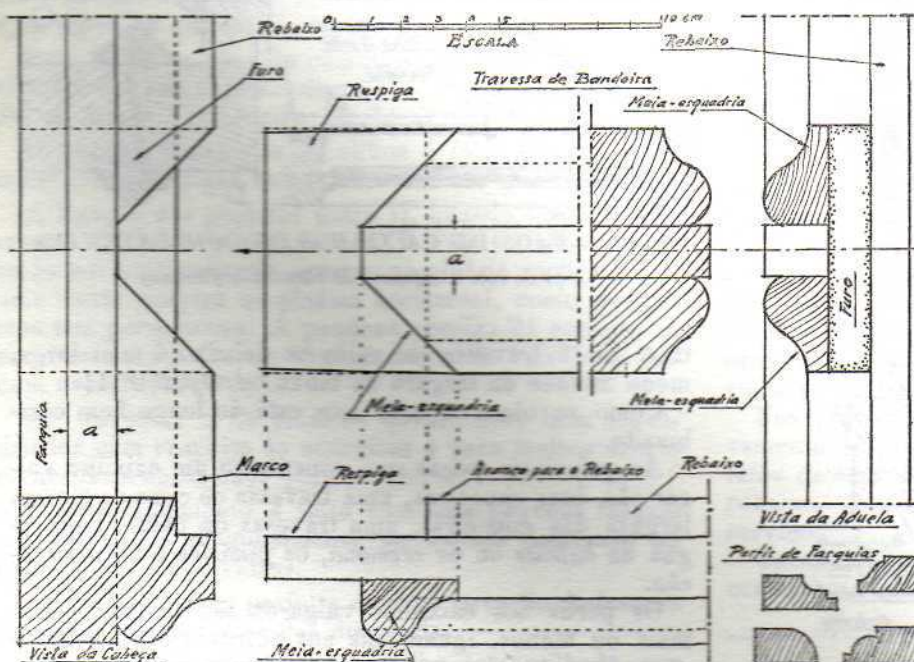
PORMENORES DA TRAVESSA DE BANDEIRA
